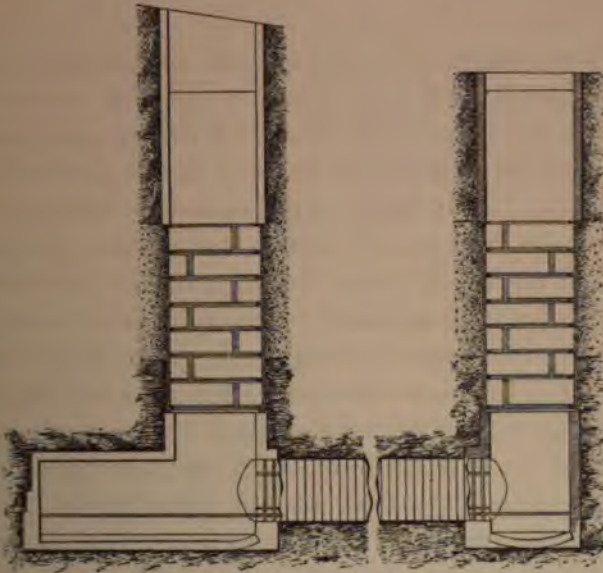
Coupe en long du souterrain de la Tour de Londres.
